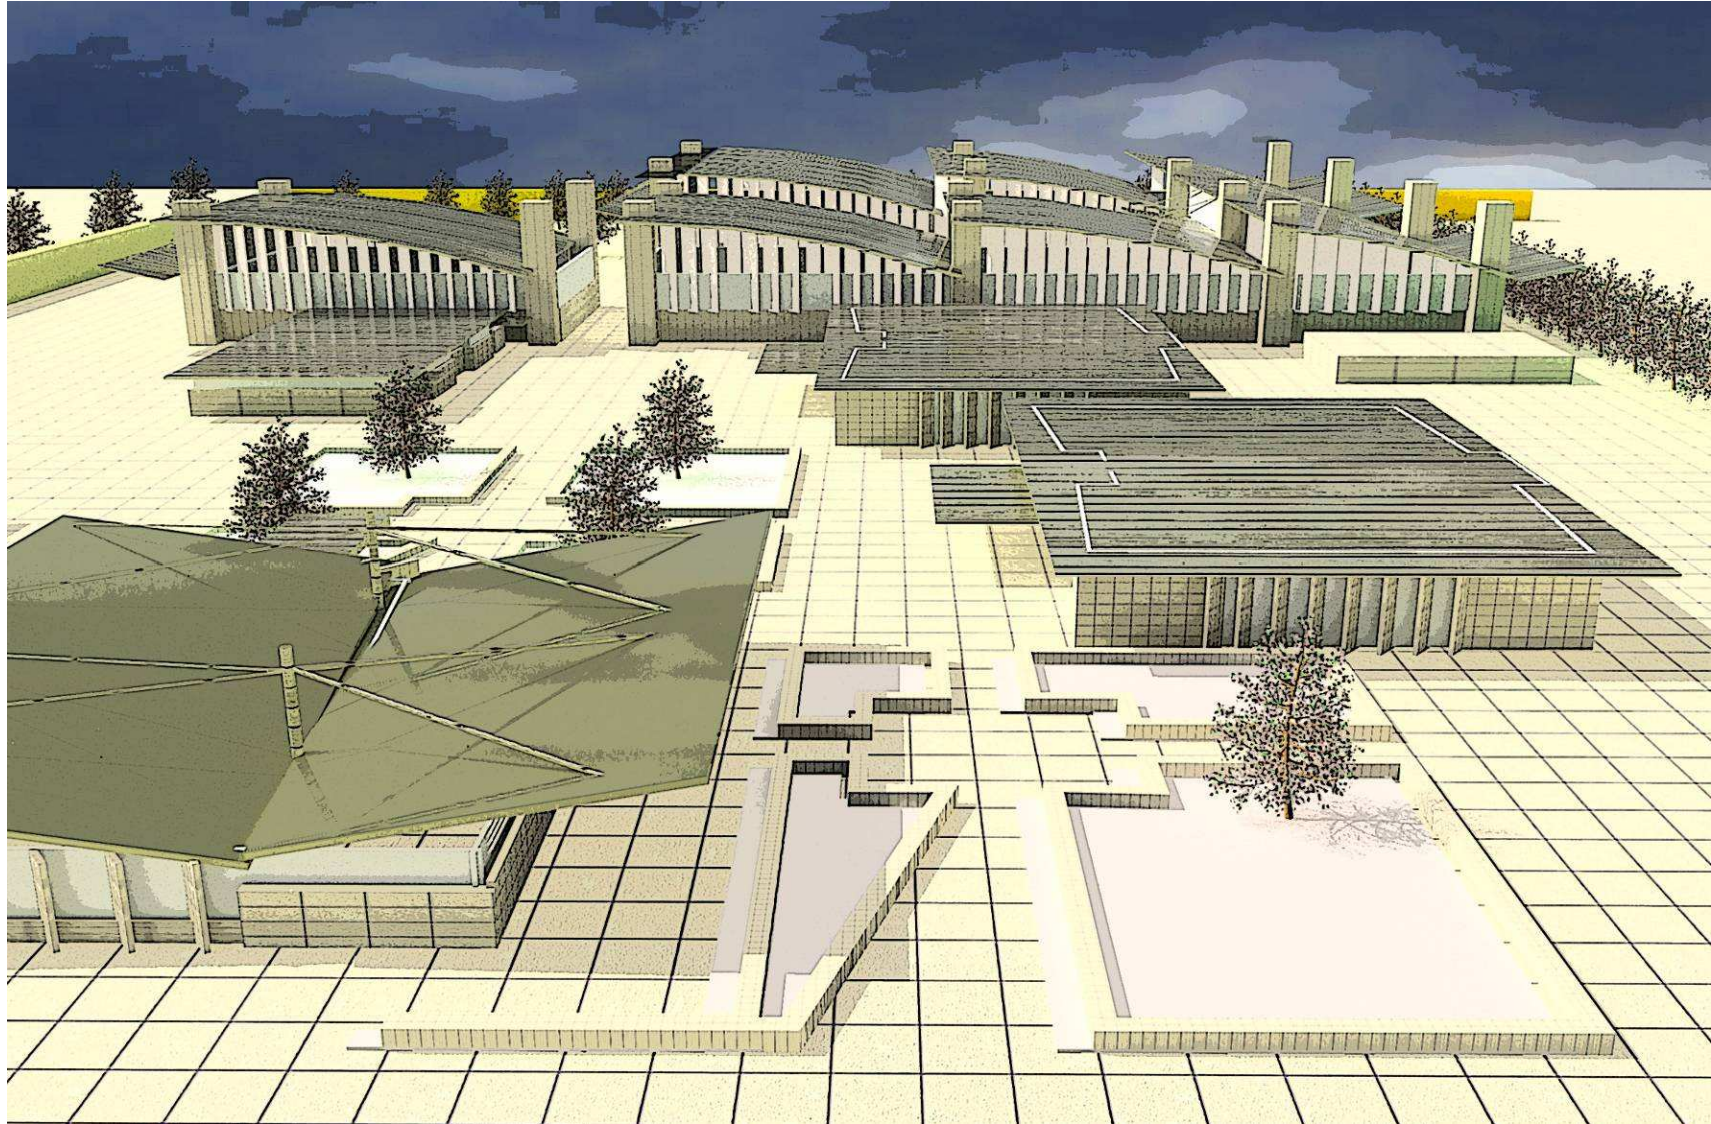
Al fondo se encuentra la zona de producción, la cual esta ligada con la plaza central del conjunto y los elementos arquitectónicos alrededor, para formar la composición del proyecto. En primer plano se encuentra el edificio de cafetería y comedor para trabajadores y la plaza pública, que es una donación a la comunidad.
